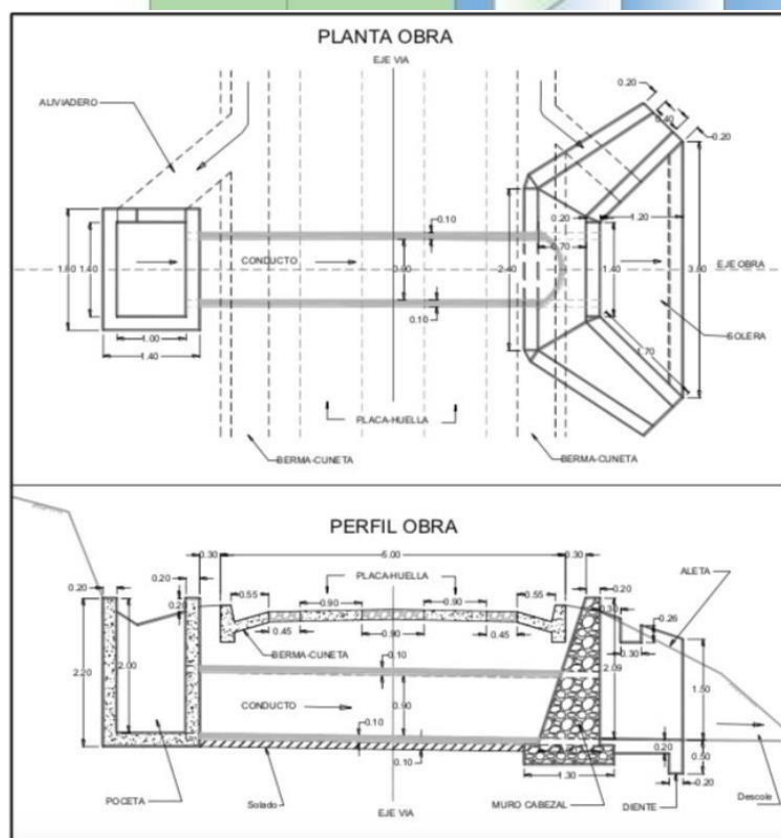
Planta y perfil de la alcantarilla típica. Fuente: Guía de Diseño de Pavimento.
